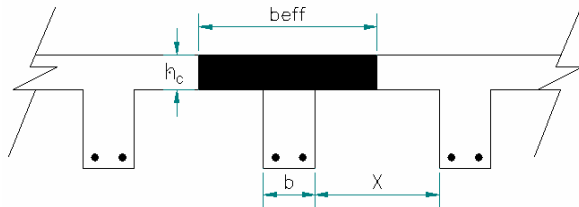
Ancho efectivo del ala para vigas con losa a ambos lados
